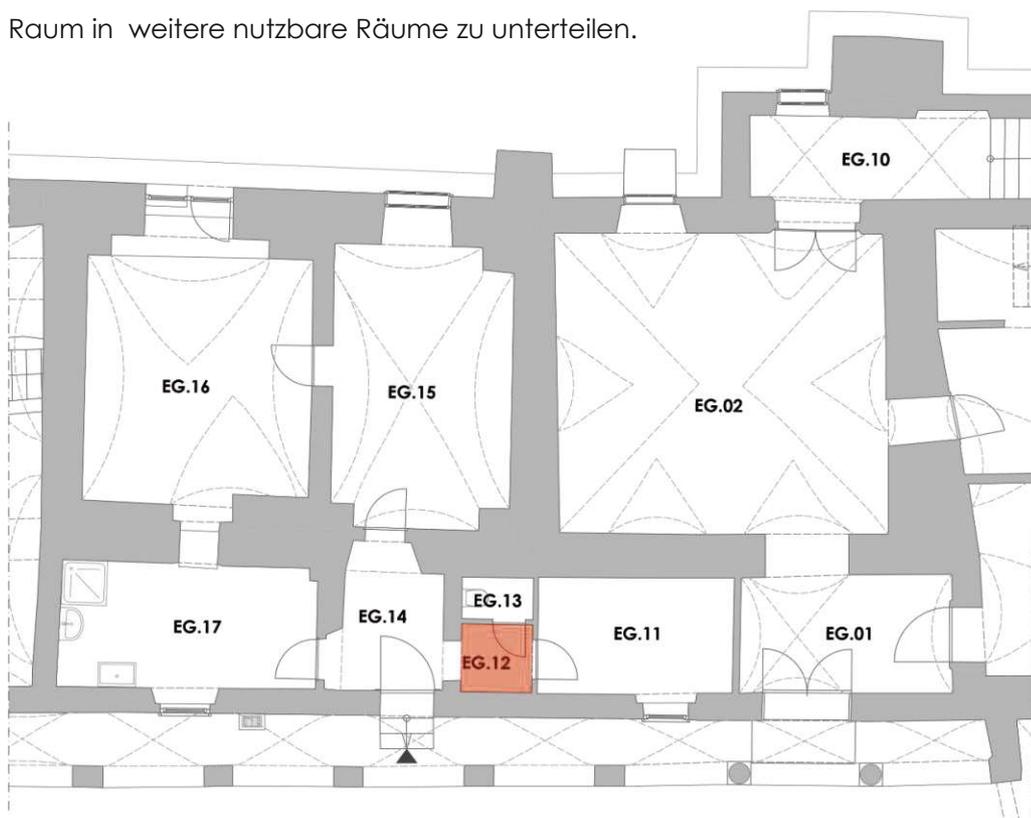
Erdgeschoss Übersichtsplan- EG.12
